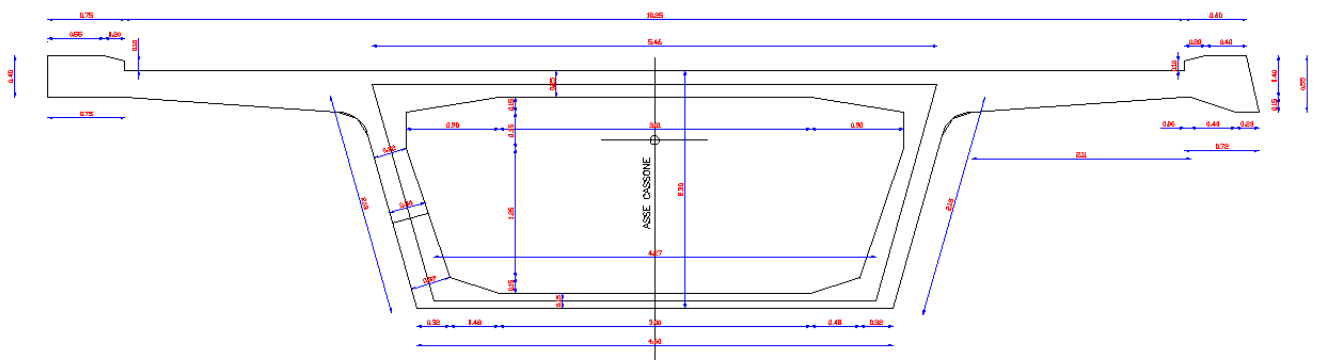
Carpenteria della sezione dell'impalcato;
